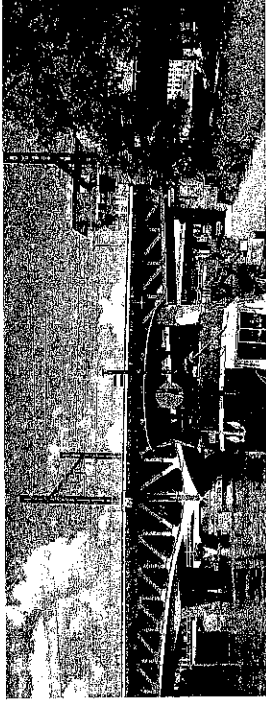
LE PONT FERROVIAIRE, PRINCIPALE SOURCE DE BRUIT SUR LE SITE
